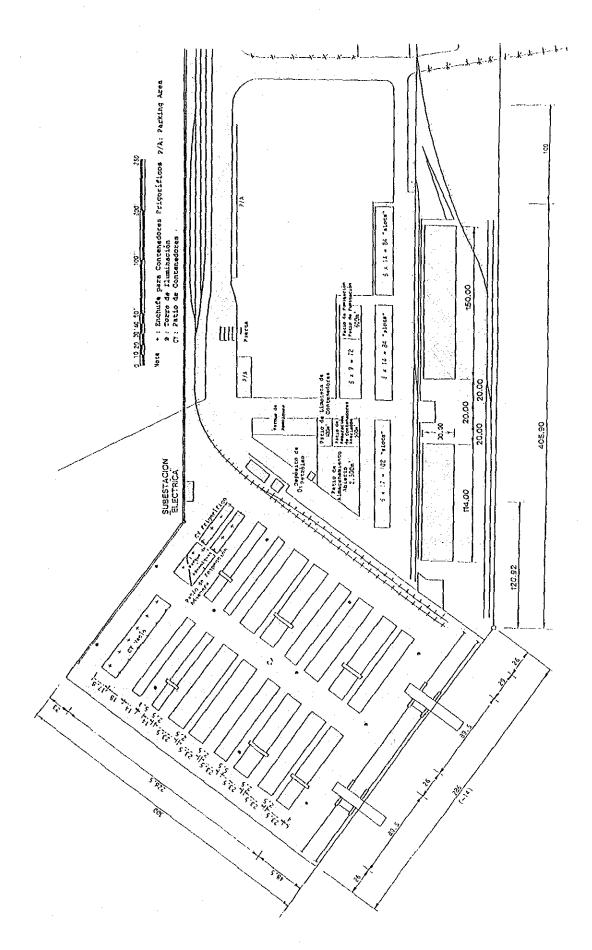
Plan de Disposición del Actual Terminal de Contenedores
